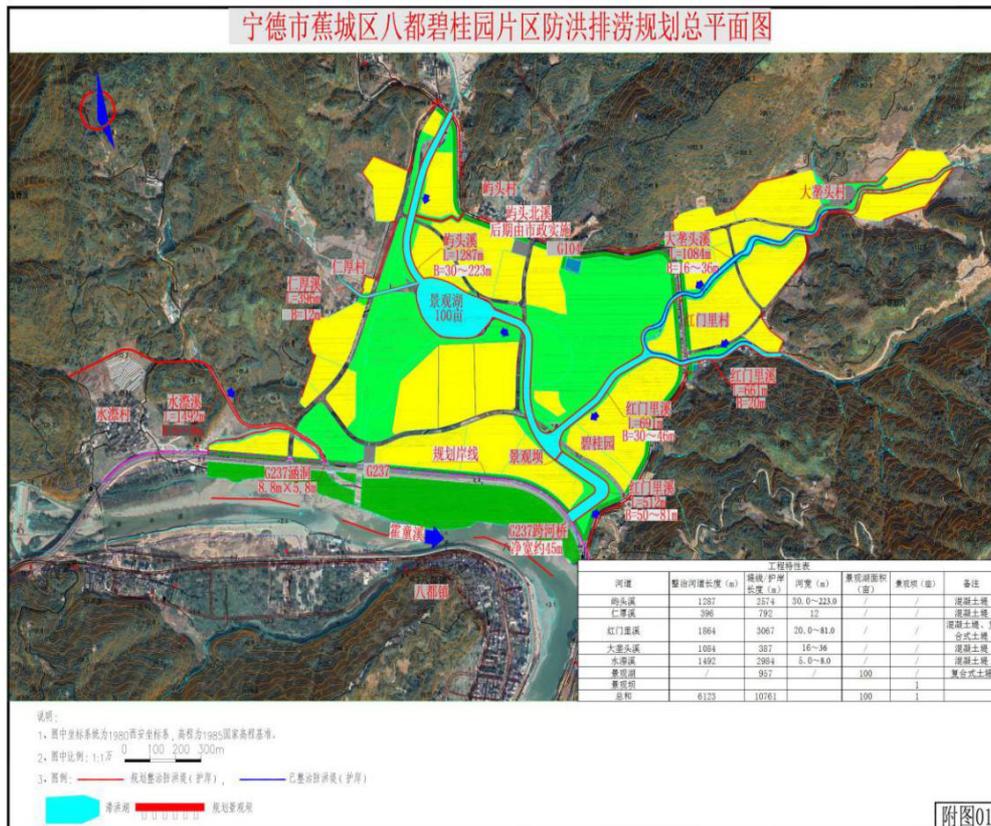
八都碧桂园片区防洪排涝规划平面布置图
